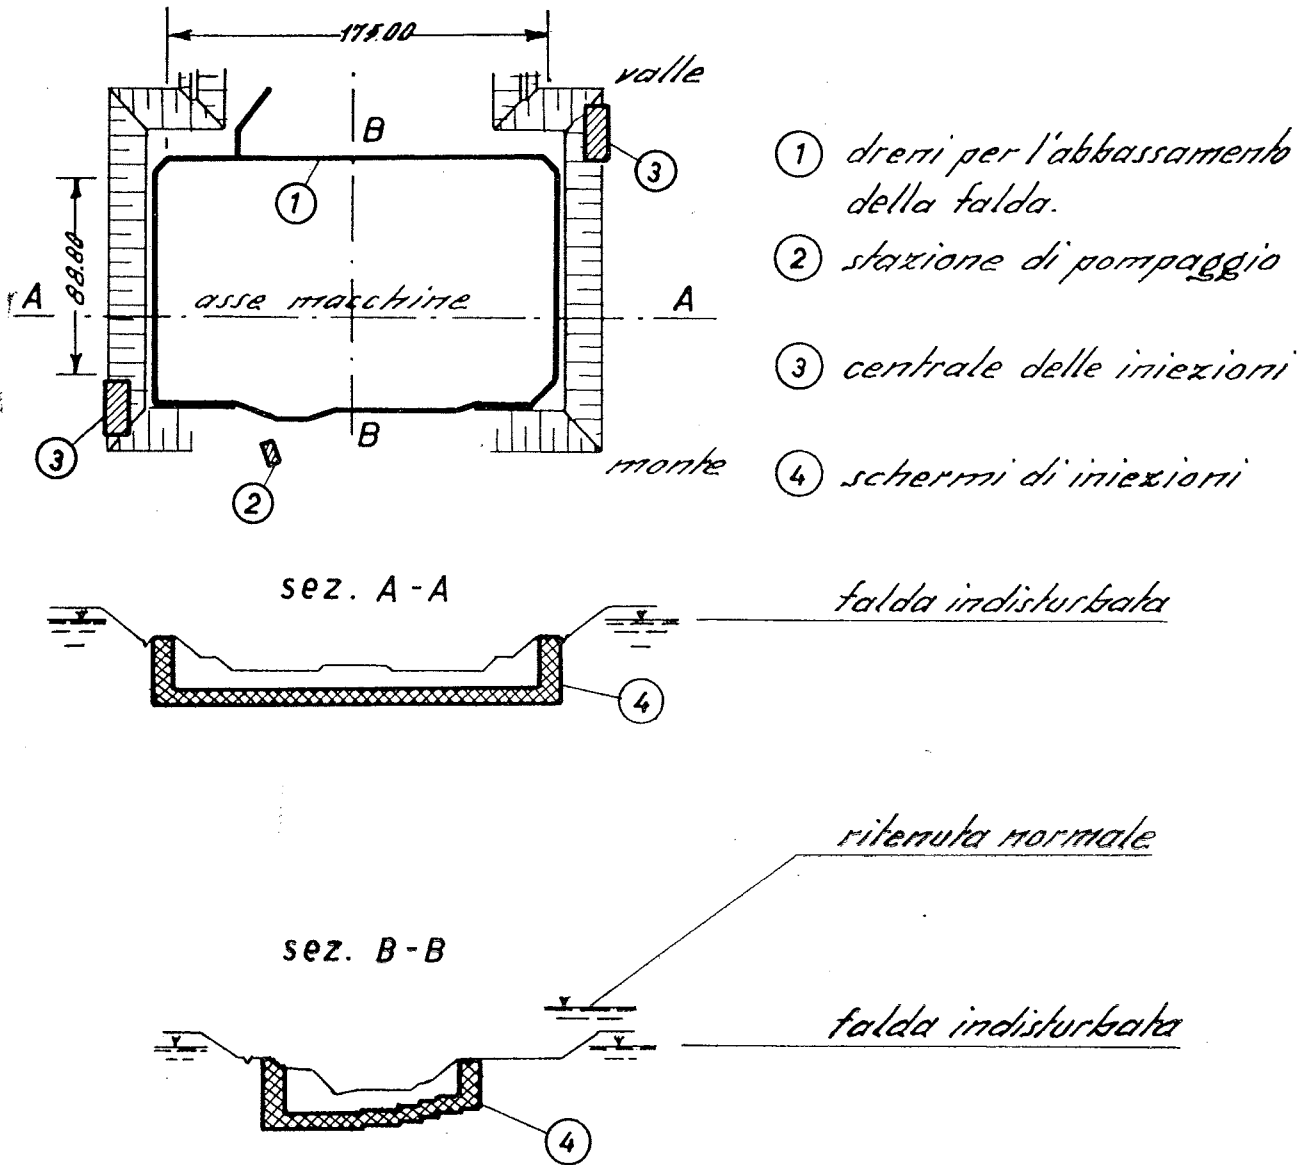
Pianta e sezioni dello scavo di fondazione della centrale con le cortine di iniezioni
